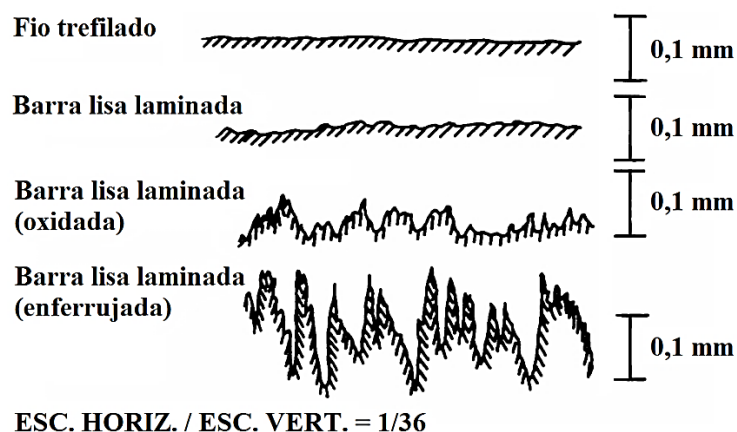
Acabamento superficial de fios e barras lisas - Modificado de França (2004).
